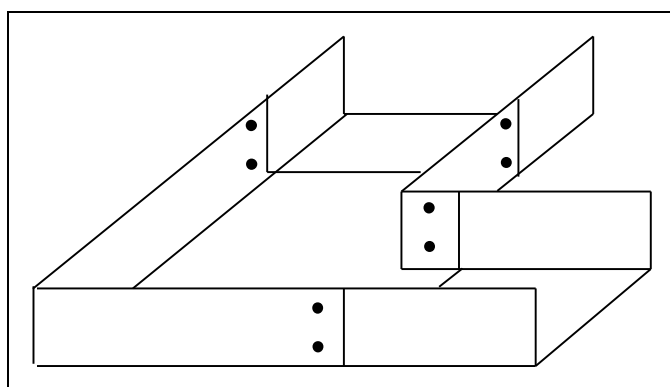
Exemplo de ligação entre esteiras de cabos em ângulo reto
